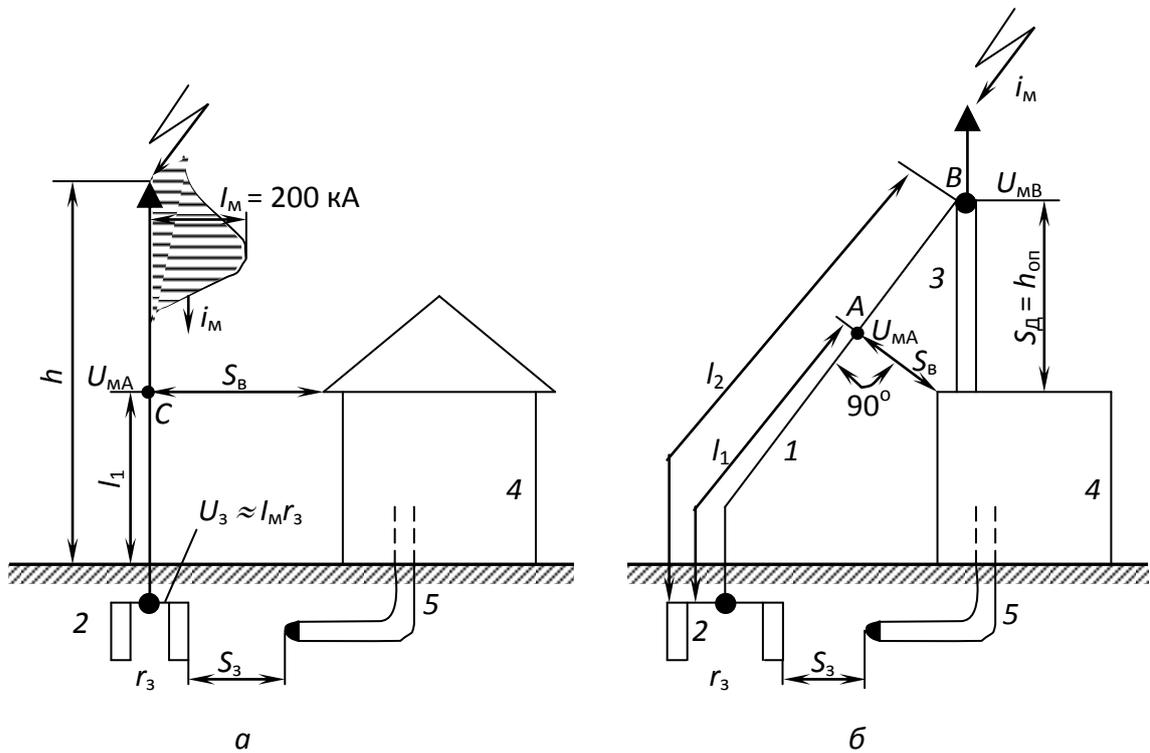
Расчетная схема определения безопасных расстояний от отдельно стоящего стержневого молниеотвода до сооружения:
